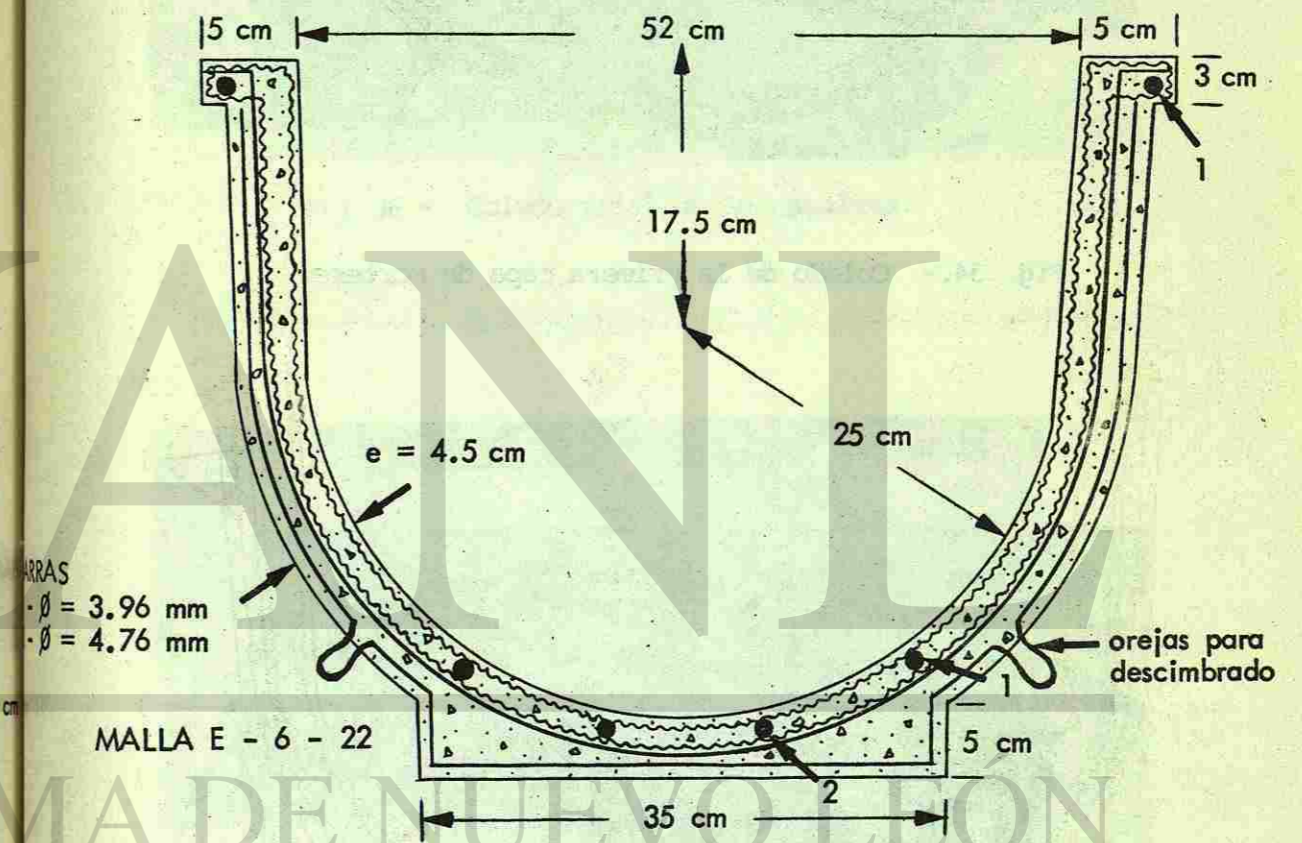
DETALLE DEL ARMADO DE LOS APOYOS
